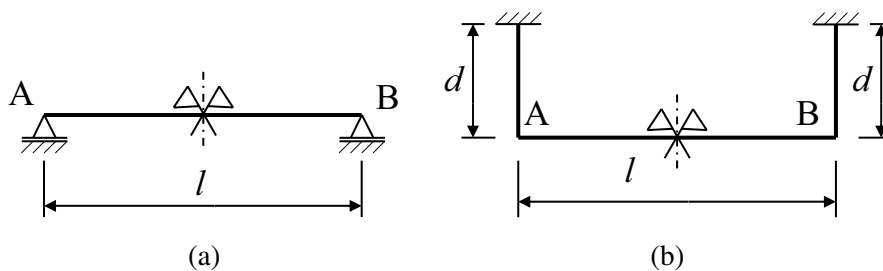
Esempi di strutture (nel piano) geometricamente simmetriche (forma della struttura e vincoli) rispetto ad un piano.
